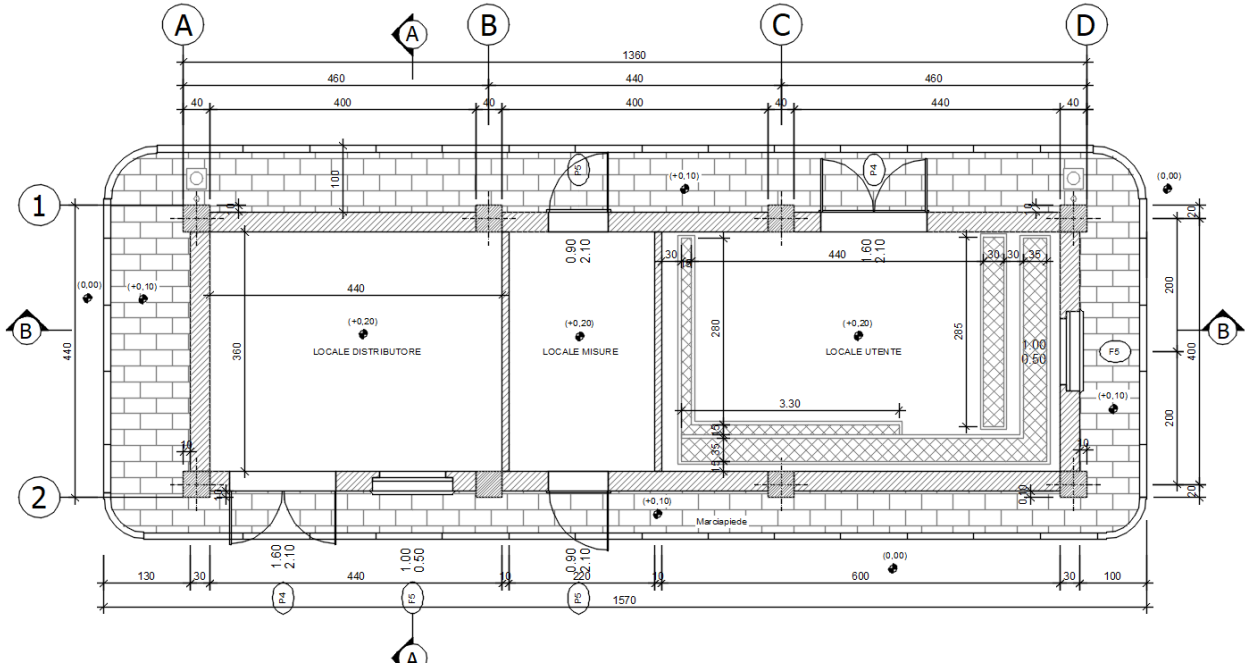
Edificio ENEL - Pianta architettonica del piano terra
